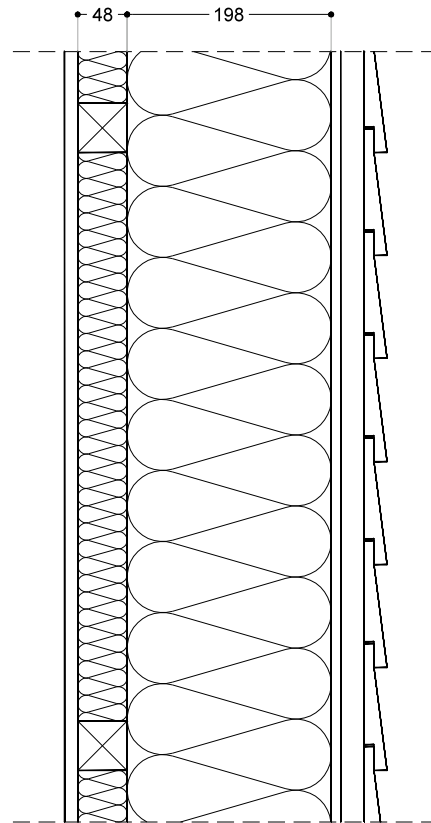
Entramado vertical de fachada con aproximadamente 200 mm de aislamiento.
